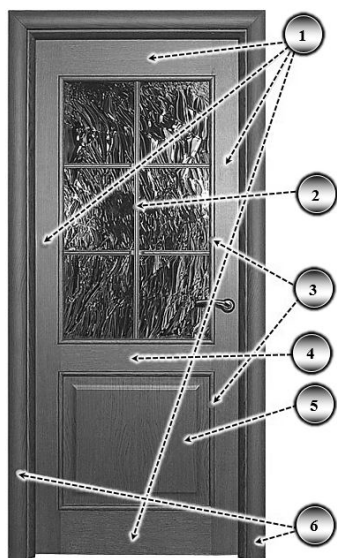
Дверь: 1 — обвязка дверного полотна; 2 — раскладка; 3 — калевка; 4 — средник; 5 — филенка; 6 — дверная обвязка
